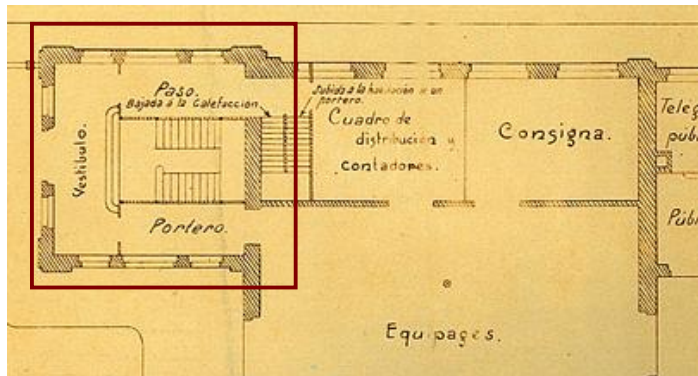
Planta de la zona del acceso al torreón izquierdo. (FFE - 2008).
